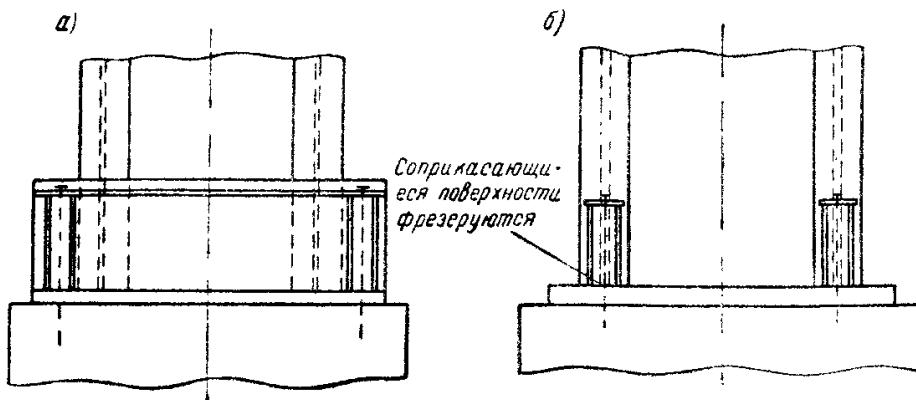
Башмаки колонн, защемленных в фундаментах
